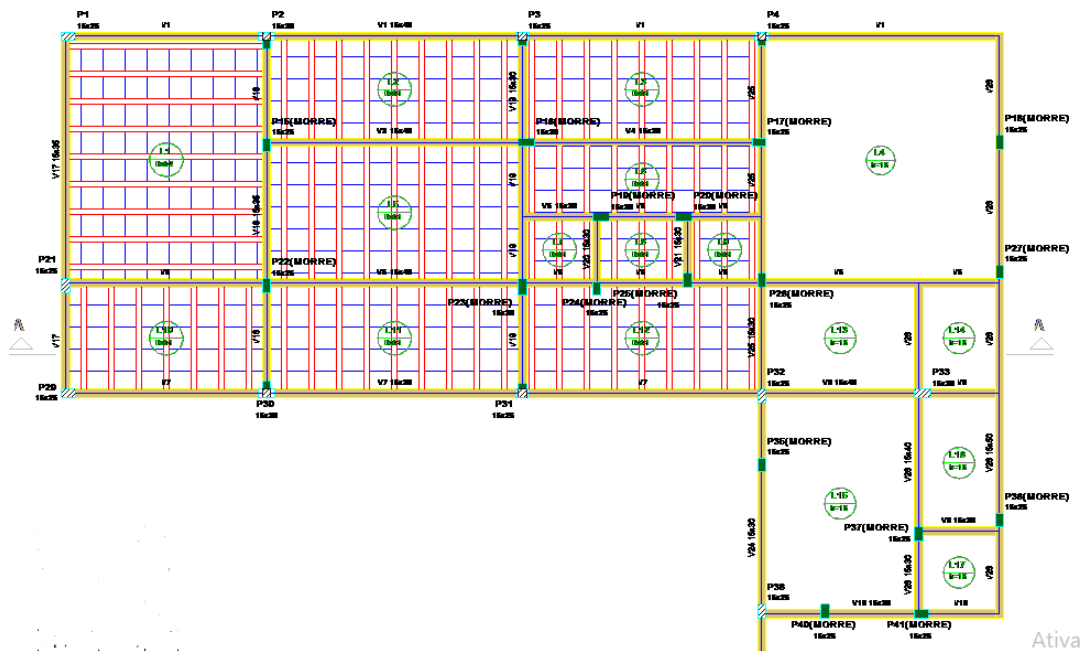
Planta de forma do primeiro pavimento do bloco Administrativo.
